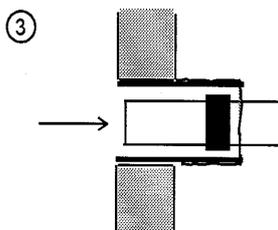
Die Hausanschlussleitung wird im Schutze des Stahlrohres zusammen mit der angebrachten Elektroschweissmuffe zurückgestossen.
